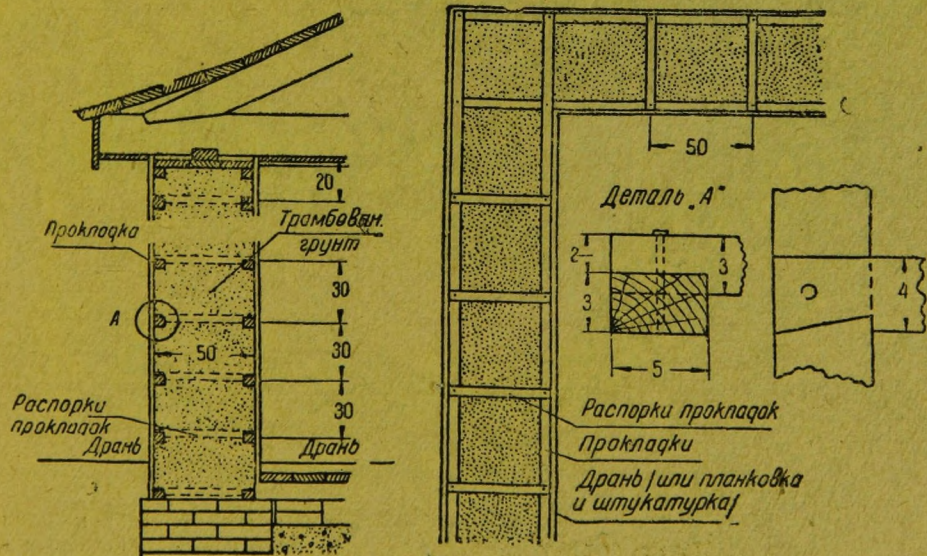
Армирование построек из грунта по сист. акад. Симинского
